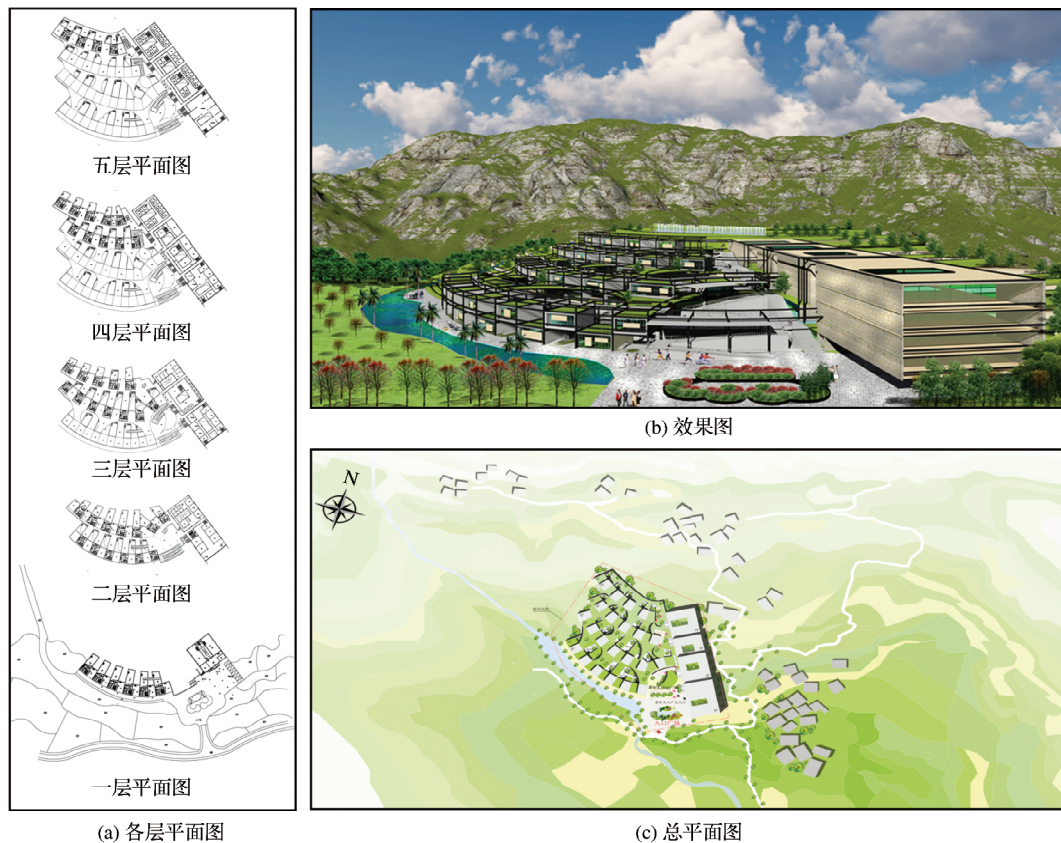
麻地坪村旅游养老社区效果图、总平面图、各层平面图
